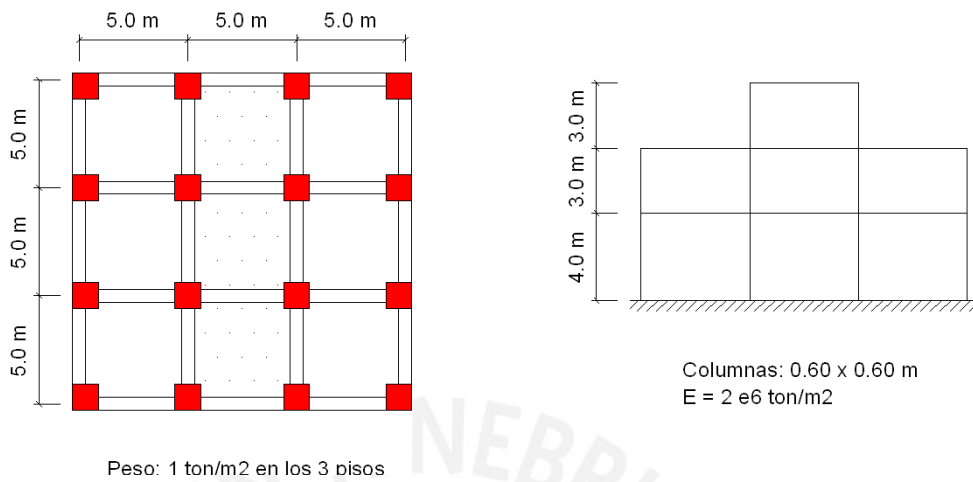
Planta y elevación de un edificio de tres niveles.
